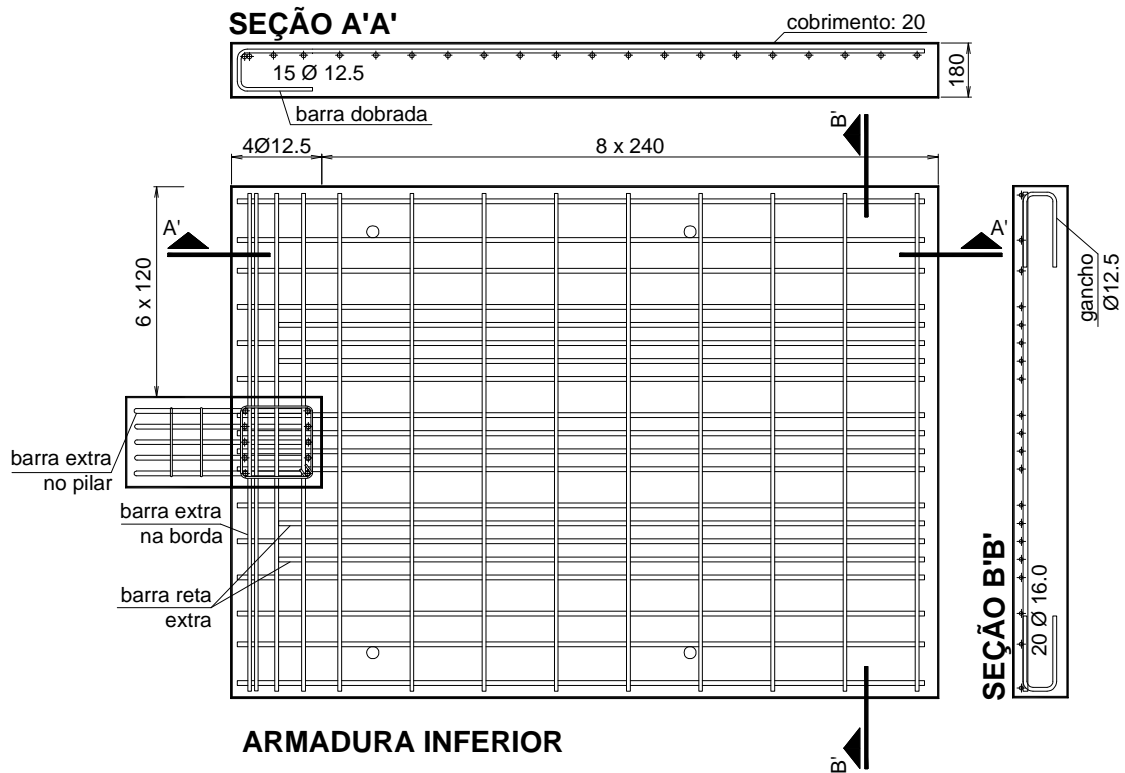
Modificação da distribuição da armadura inferior e do pilar (L08)
